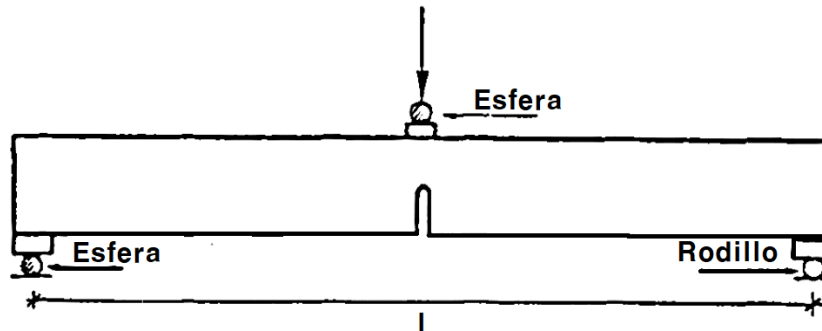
Esquema estándar de viga de concreto, vista de frente. [30]
